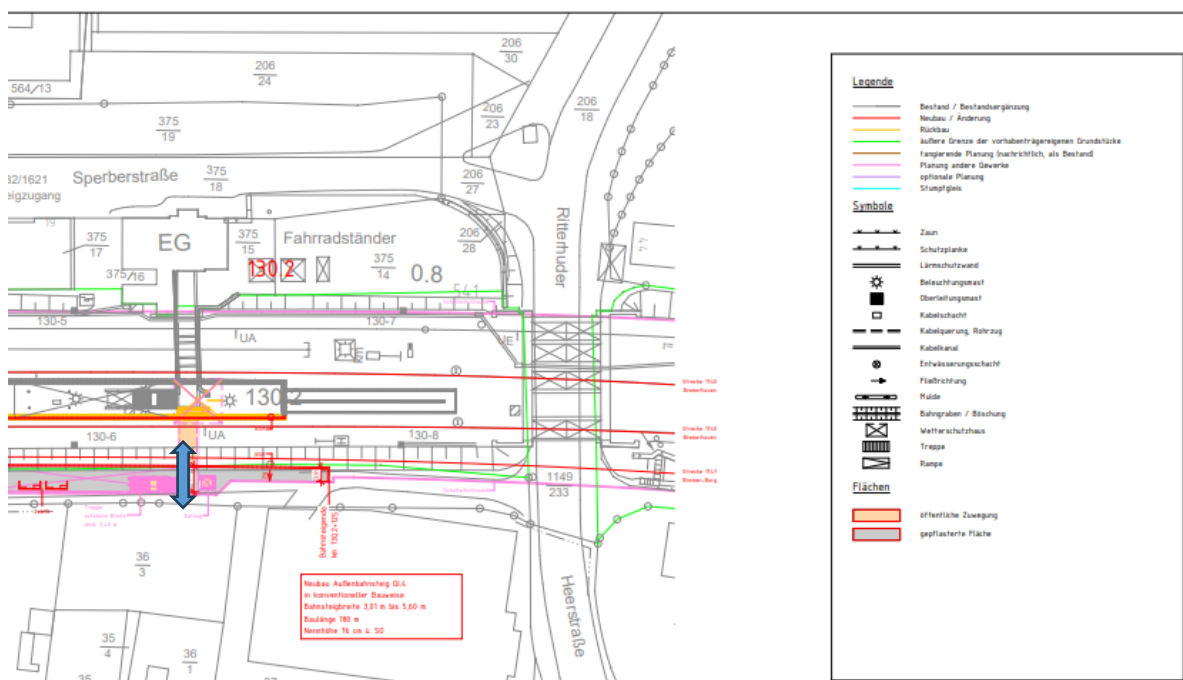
Lageplan Bremen-Oslebshausen mit Durchstich
